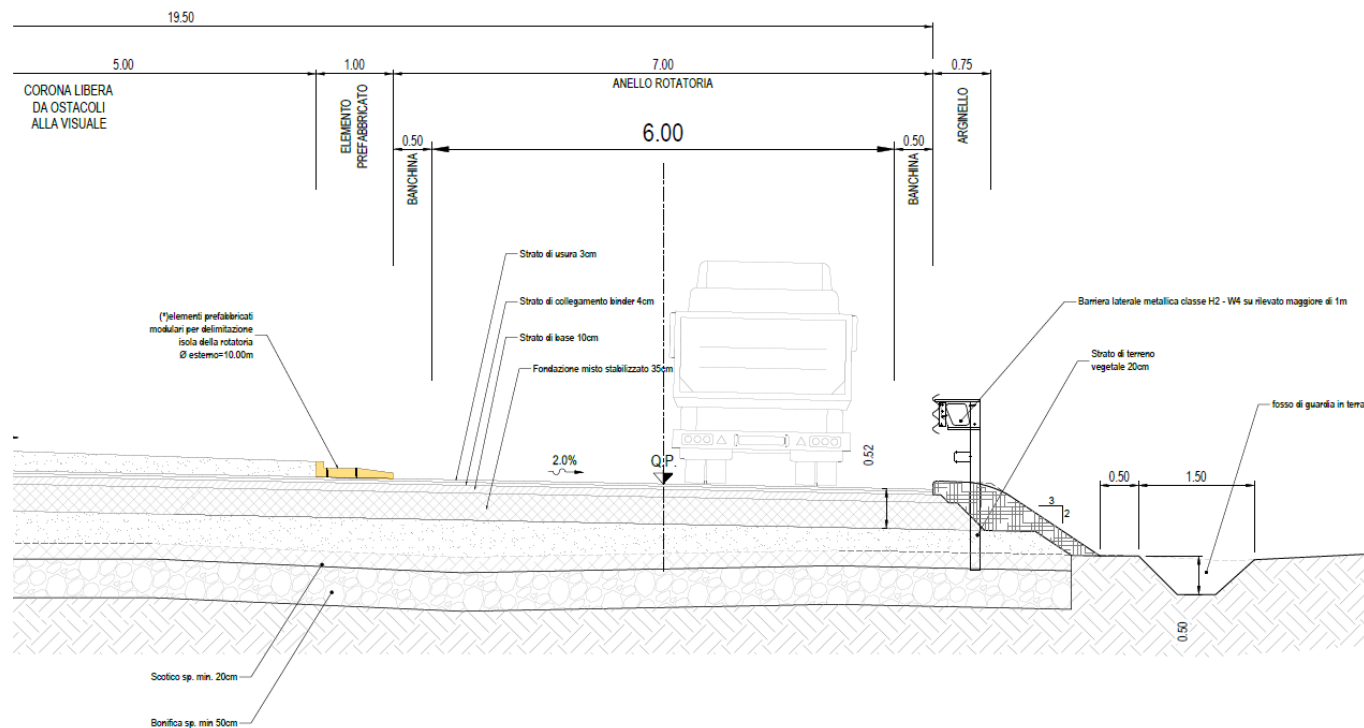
Sezione tipo isola centrale rotondina S.S. 90
